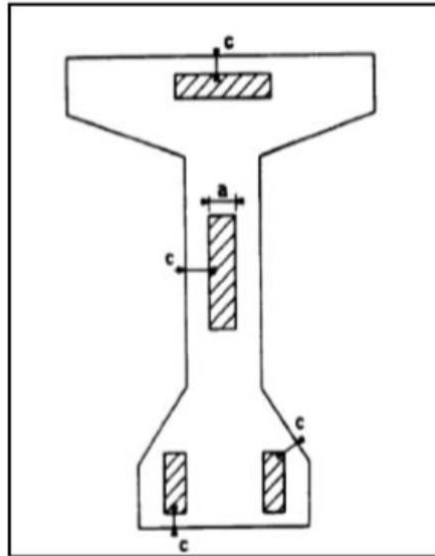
L'enrobage minimale c d'une conduite (gaine)
